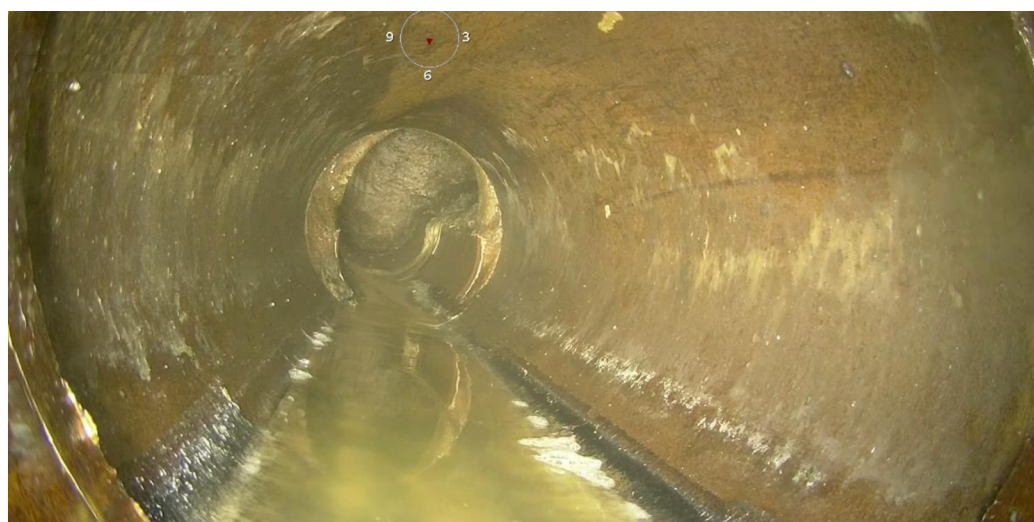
37.02 m – Detail netěsností, silných prasklin a vymleté díry nad potrubím [BVK,a.s]
